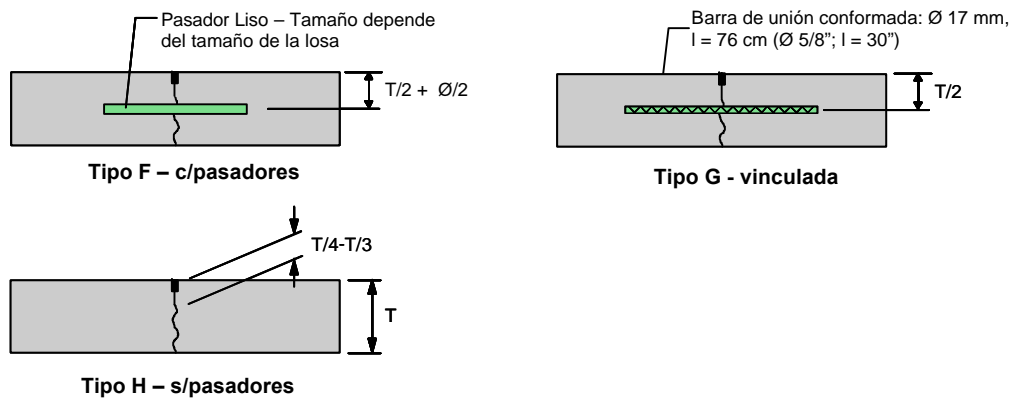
Tipos de juntas para pavimentos de concreto para aeropuertos (cortesía de la Asociación Norteamericana de Pavimentos de Concreto, ACPA)
